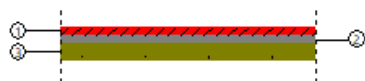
Cubiertas vivienda. (Fuente: propia, Lumion)
